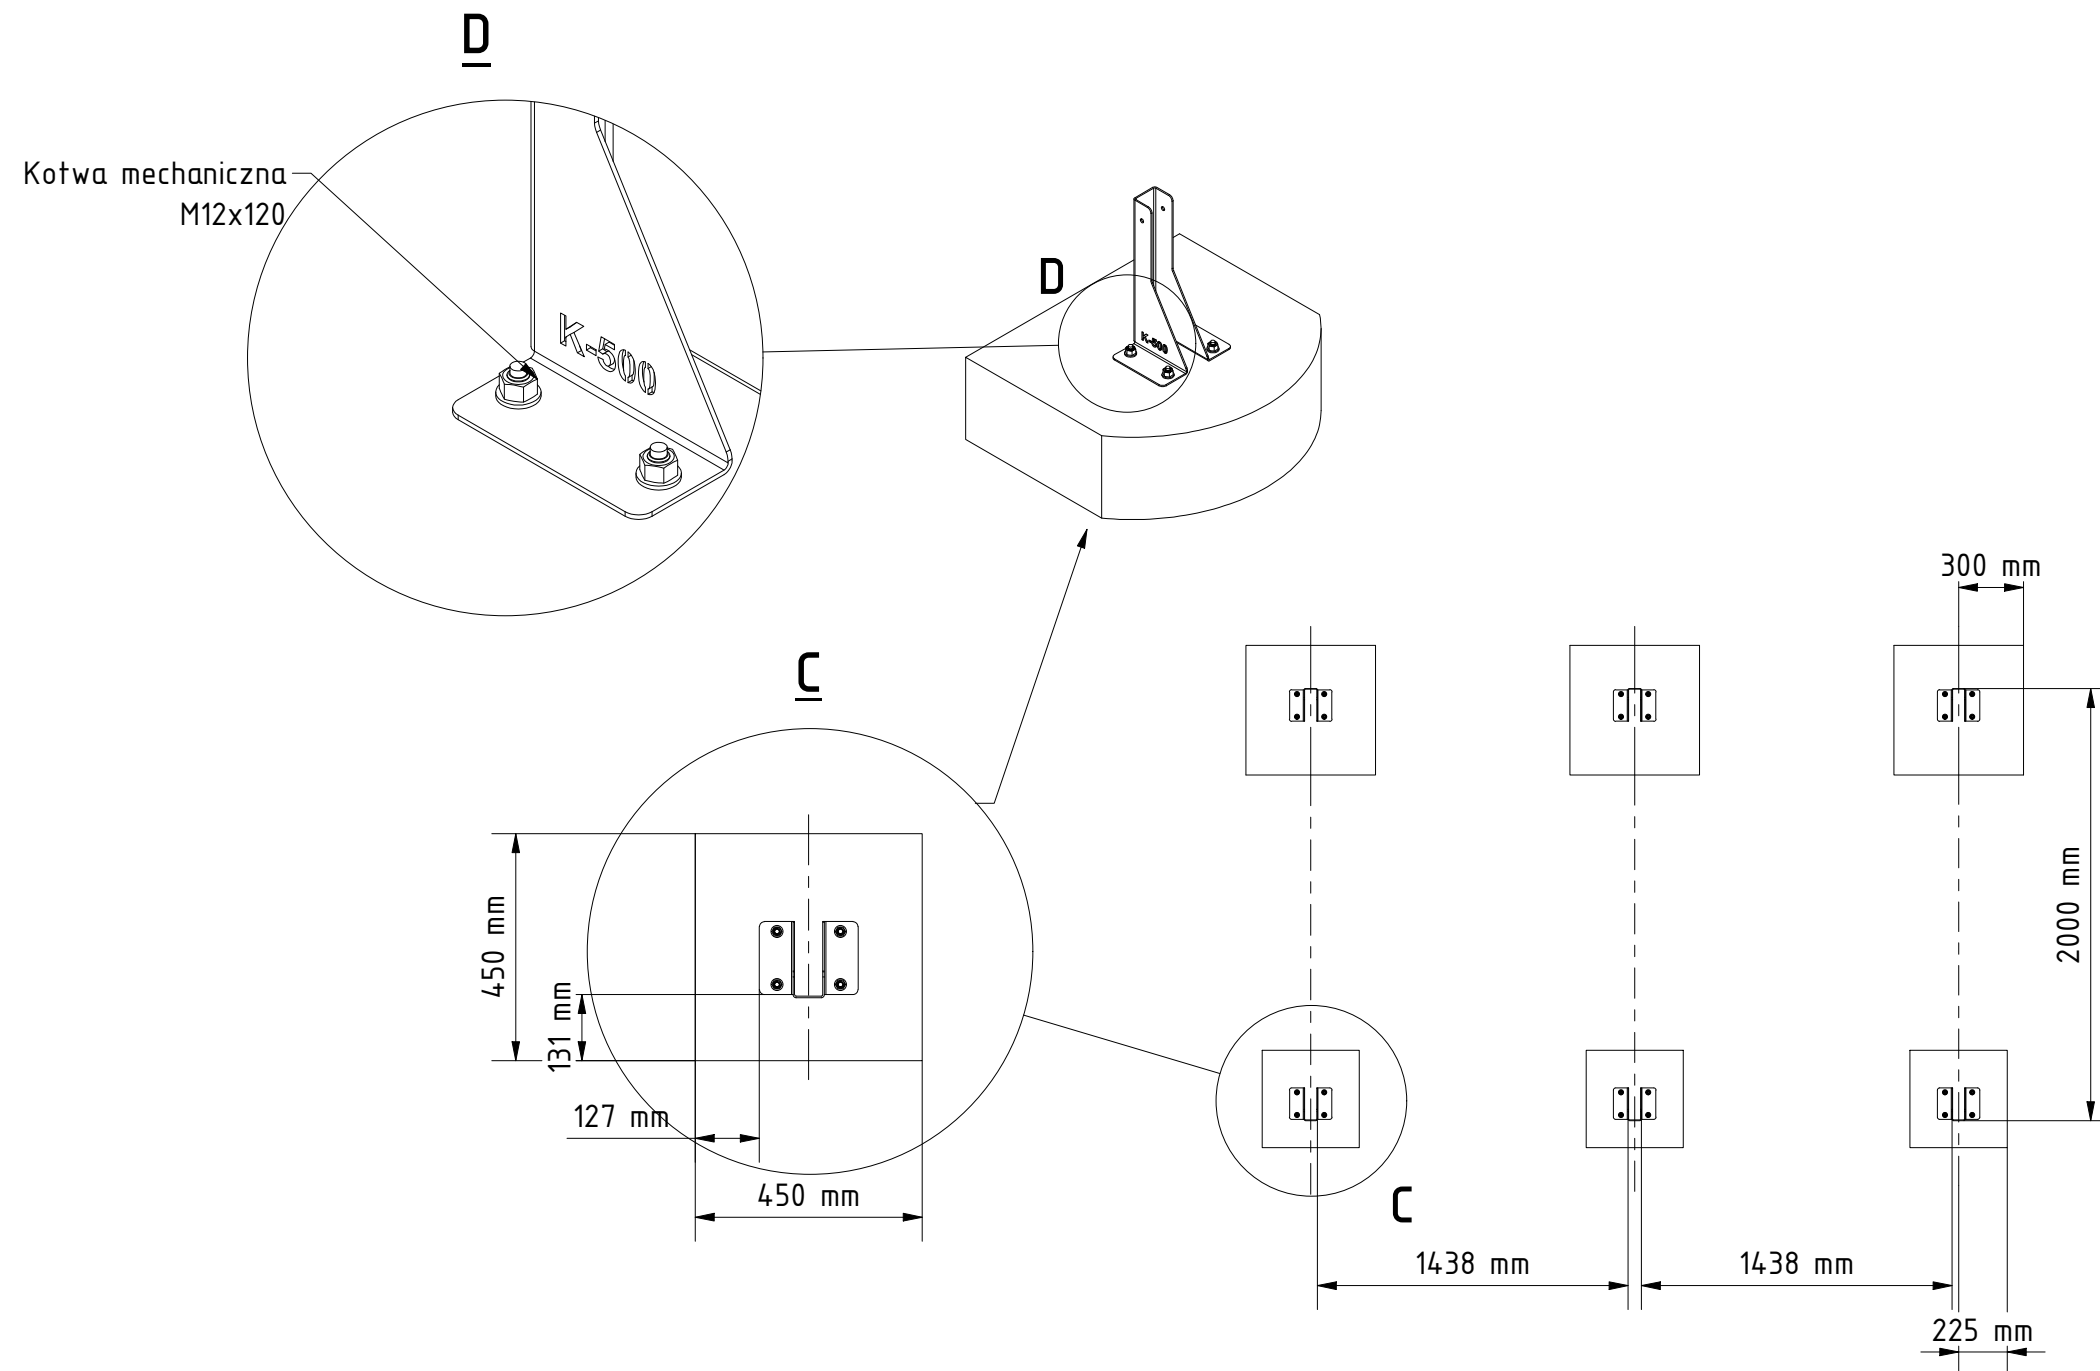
Montaż podstawy betonowej (A) na wylewce wykonanej w formie fundamentów
